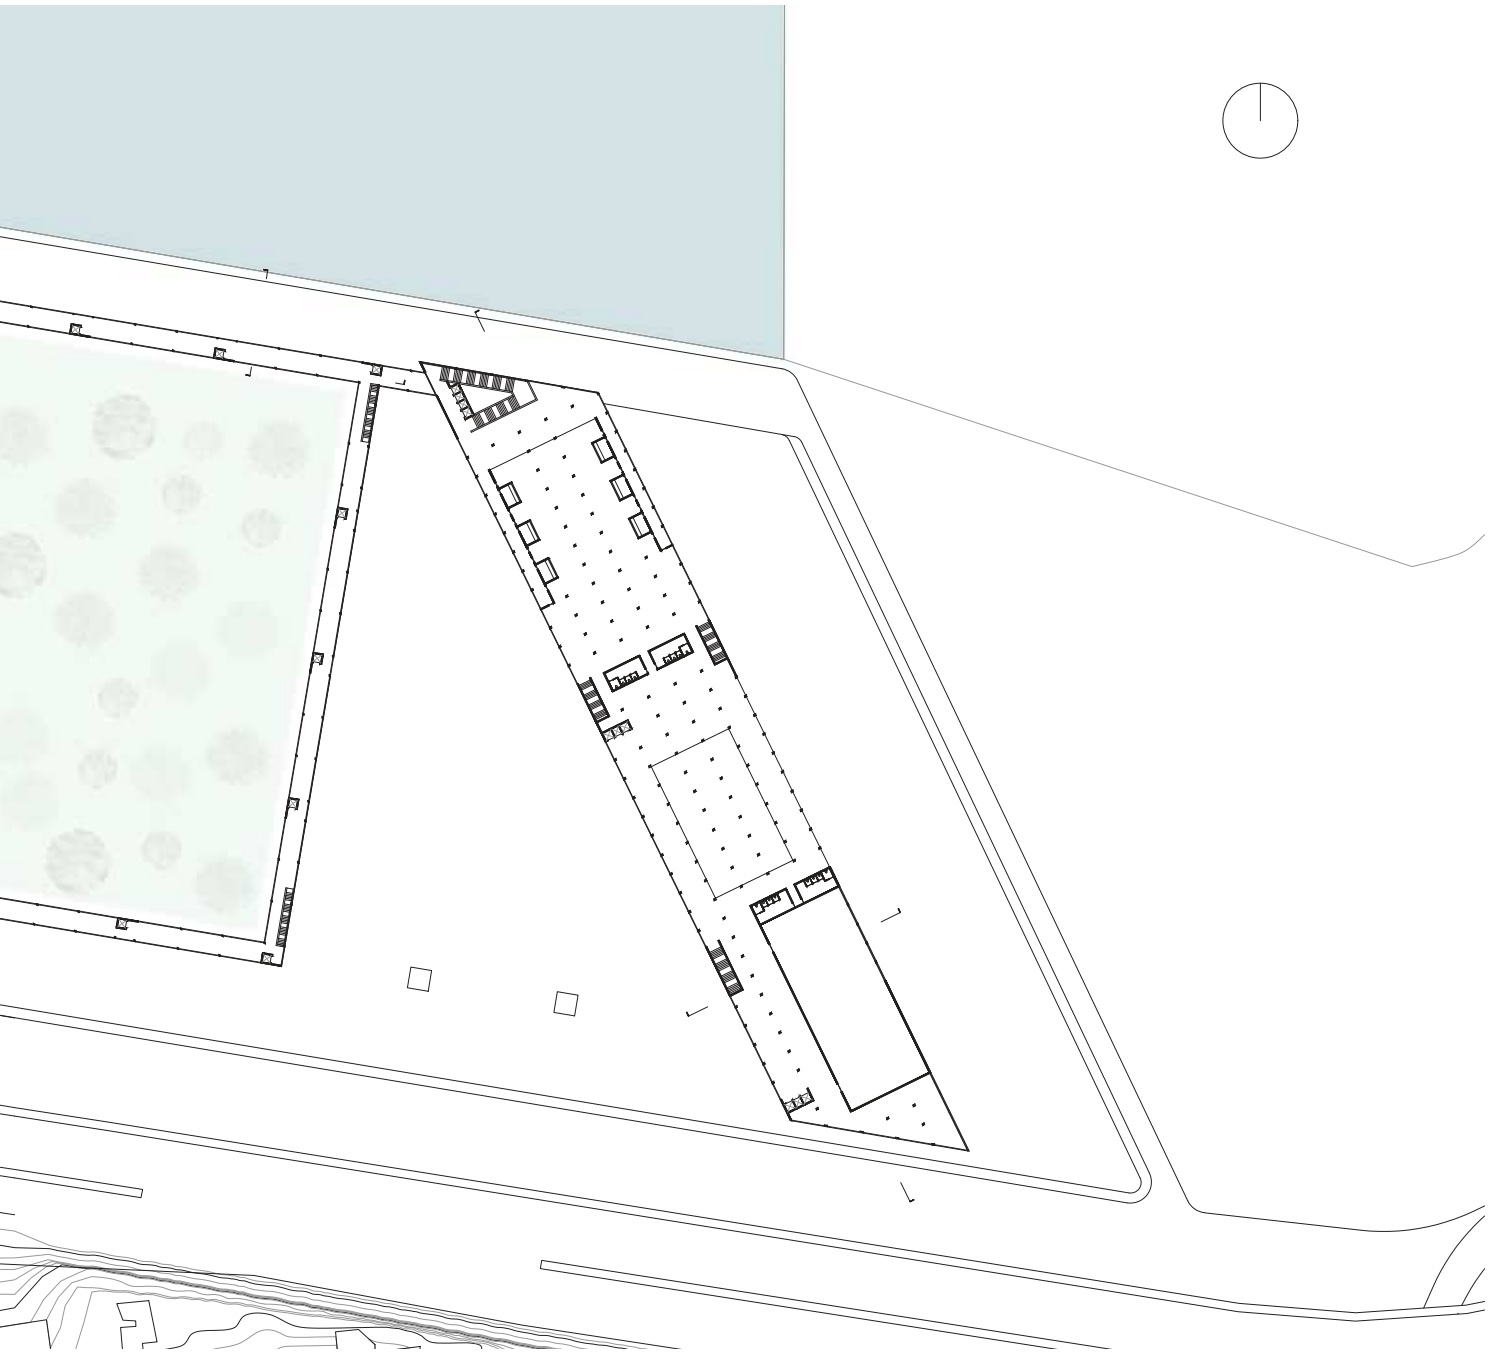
PLANTA DO PISO 2 DO TERMINAL E DO PISO SUPERIOR DA ESTRUTURA
